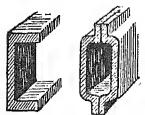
Exemples de sections de poutres métalliques utilisées pour longerons.
